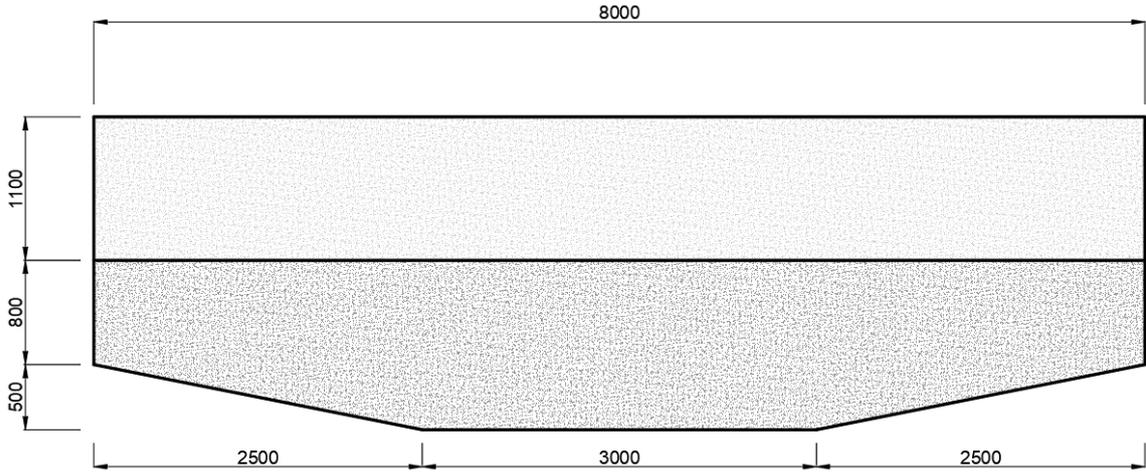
Sección longitudinal de la viga cabezal [Elaboración propia]
